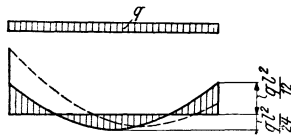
M-Verlauf beim fest eingespannten Träger mit Voute links (strichliert) und ohne Vouten (voll).
